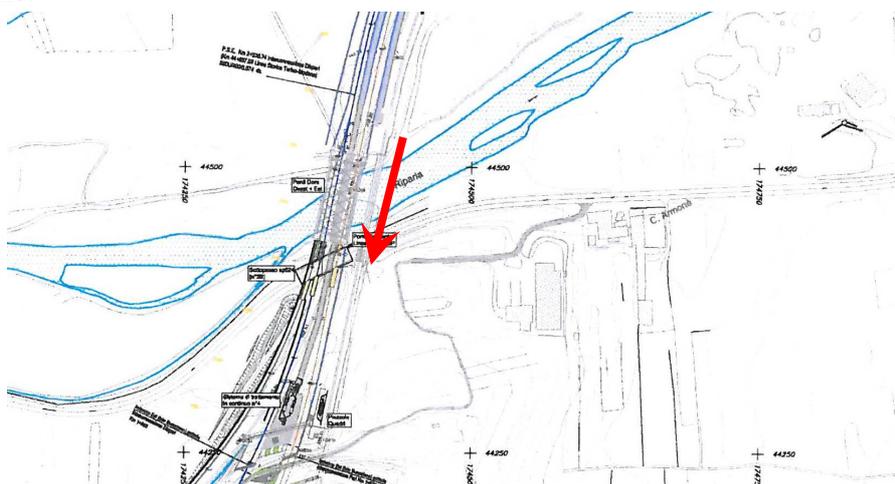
Difesa spondale nel tratto interessato dalla galleria artificiale della SP24
